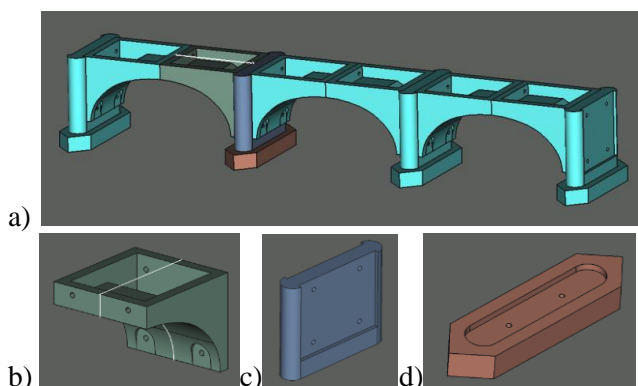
Modèle CAO 3D d'un élément de pont (a) structure complète, (b) demi-arche, (c) pile, (d) semelle (Badinier)
